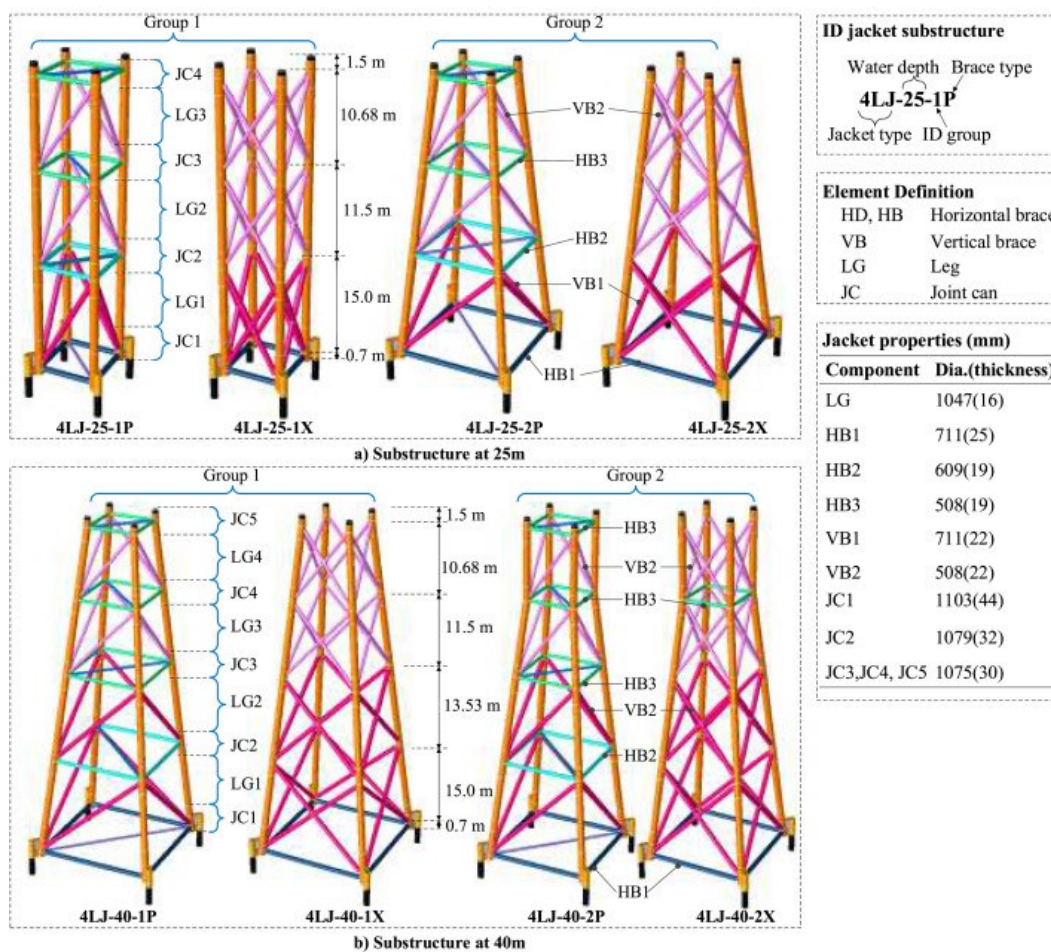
16: Tipici di fondazione fissa per varie profondità di fondale [Fonte: Referenza [3]]
